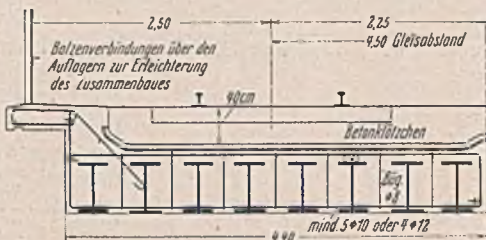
Querschnitt eines Überbaues aus einbetonierten Stahlträgern mit Querbewehrung aus Rundisen.
